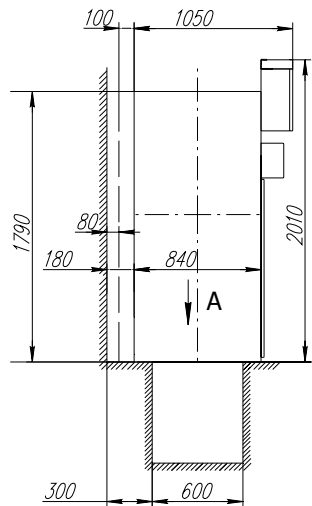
Габаритные размеры КСО с шириной корпуса 375 мм
